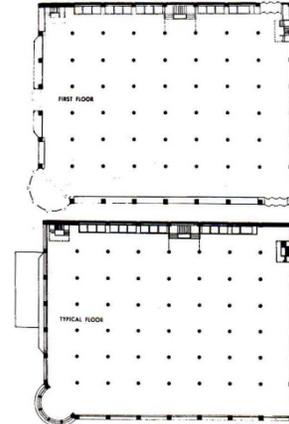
Planta típica y de primer nivel Edificio Carson, Pirie Scott & Co.
